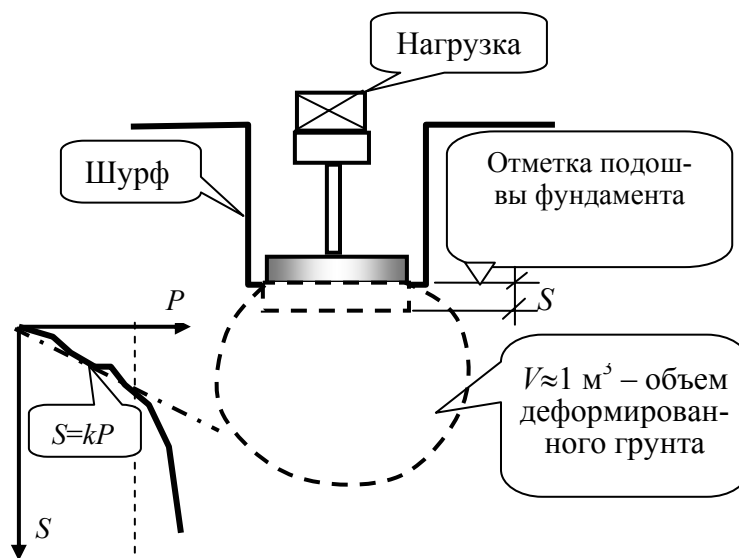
Штамповые испытания грунта в котловане в полевых условиях
